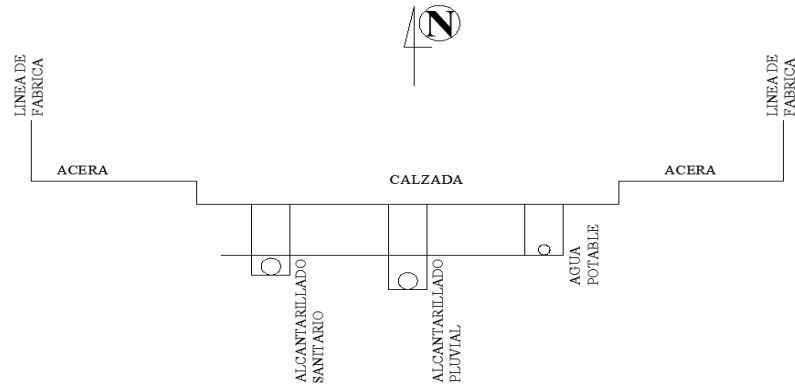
Esquema para la colocación del Alcantarillado Sanitario
